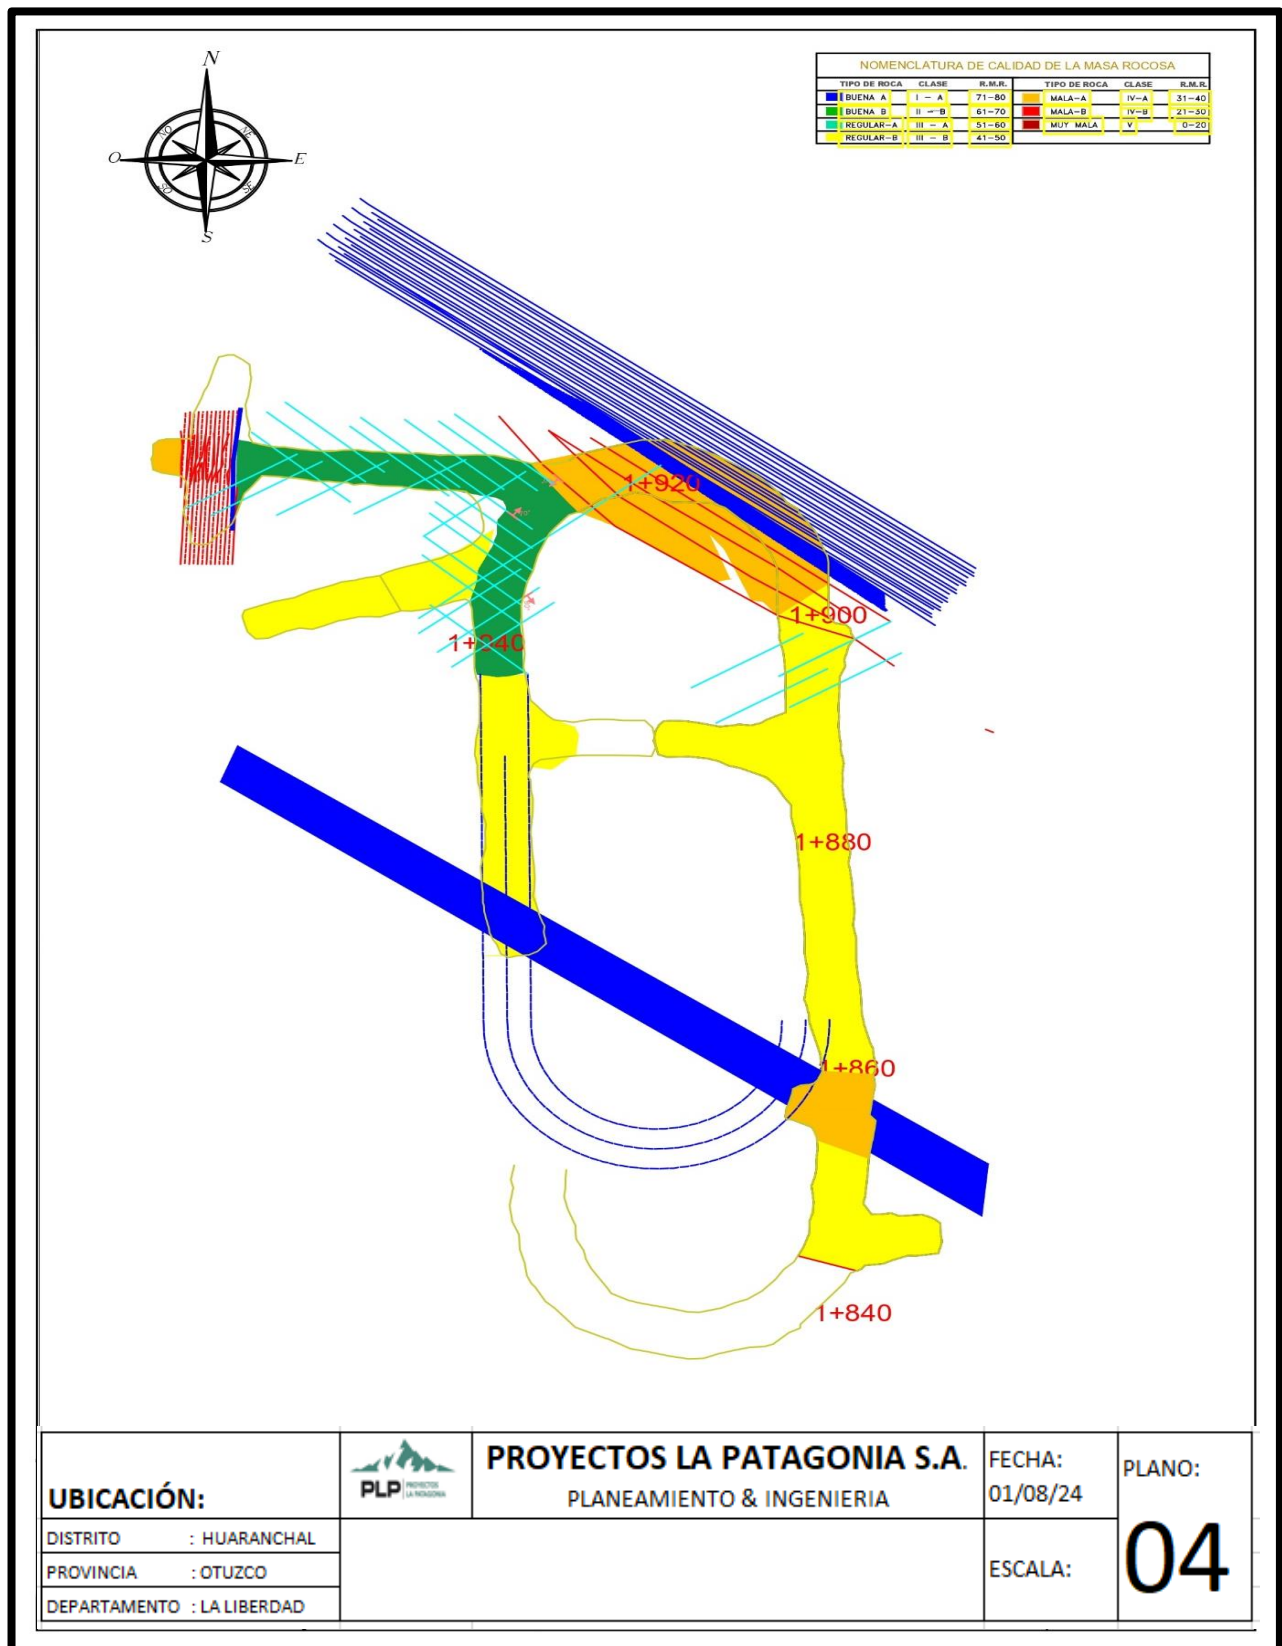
Acceso de la rampa Chimú a la galería 4139N.
